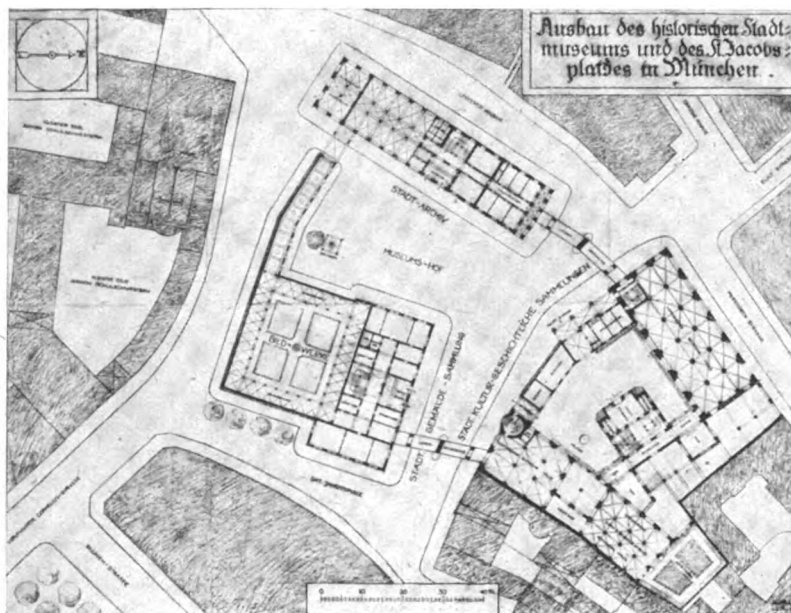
Erdgeschoß-Grundriß der Museumsanlage.
